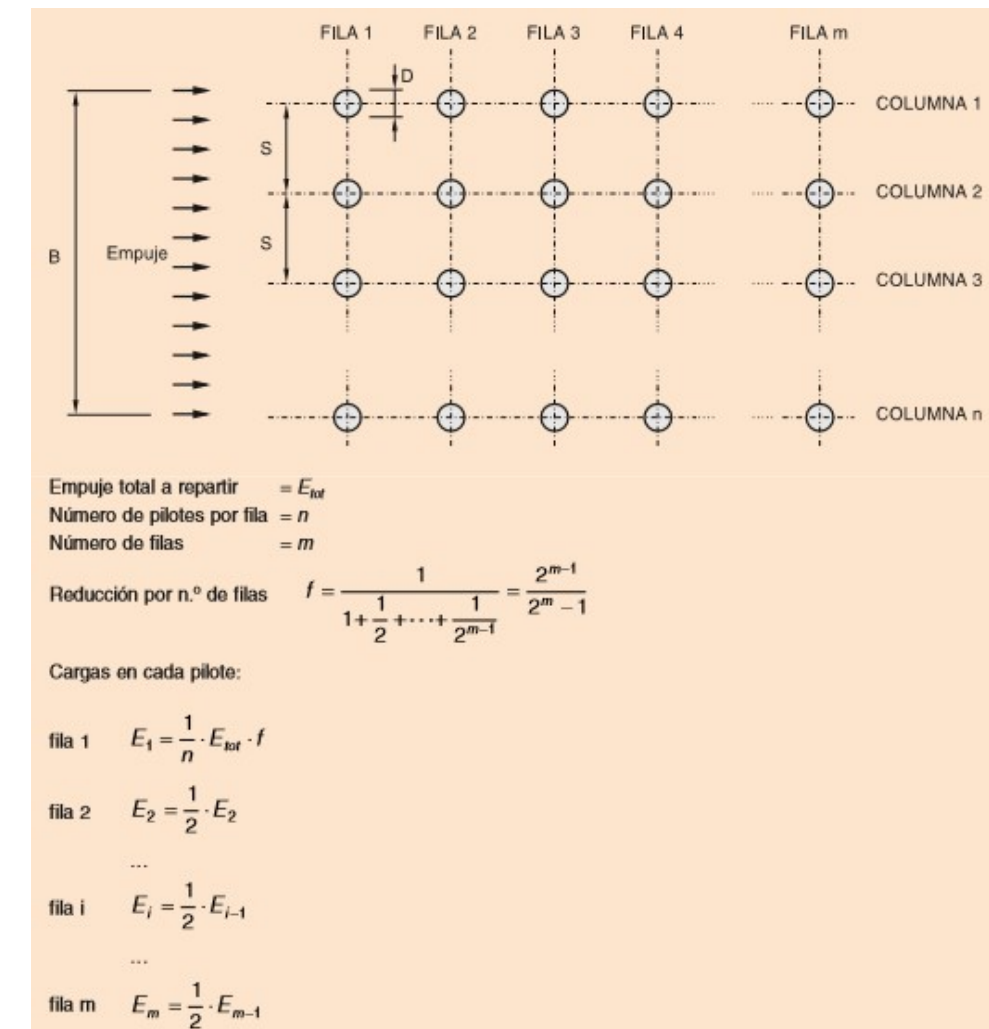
Reparto de esfuerzos horizontales perpendiculares al plano del estribo en los pilotes
